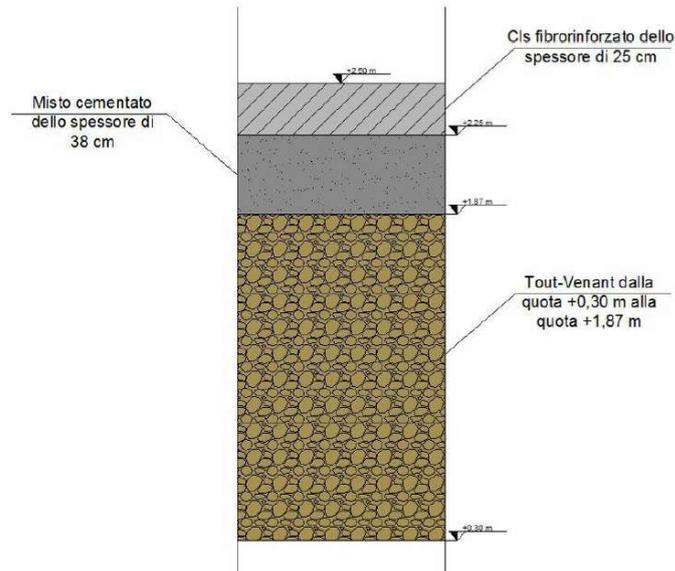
Sezione tipo della pavimentazione del piazzale
